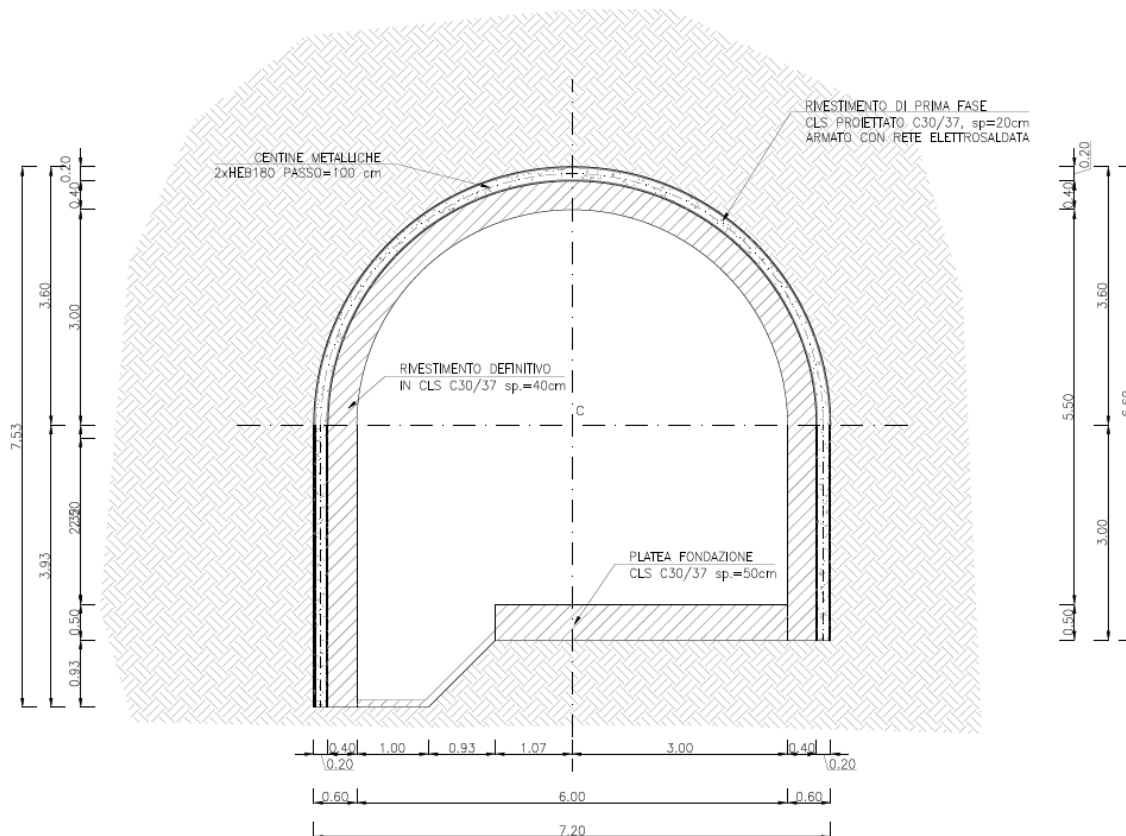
Sezione tipo GV-2: geometria del cavo e interventi di sostegno
